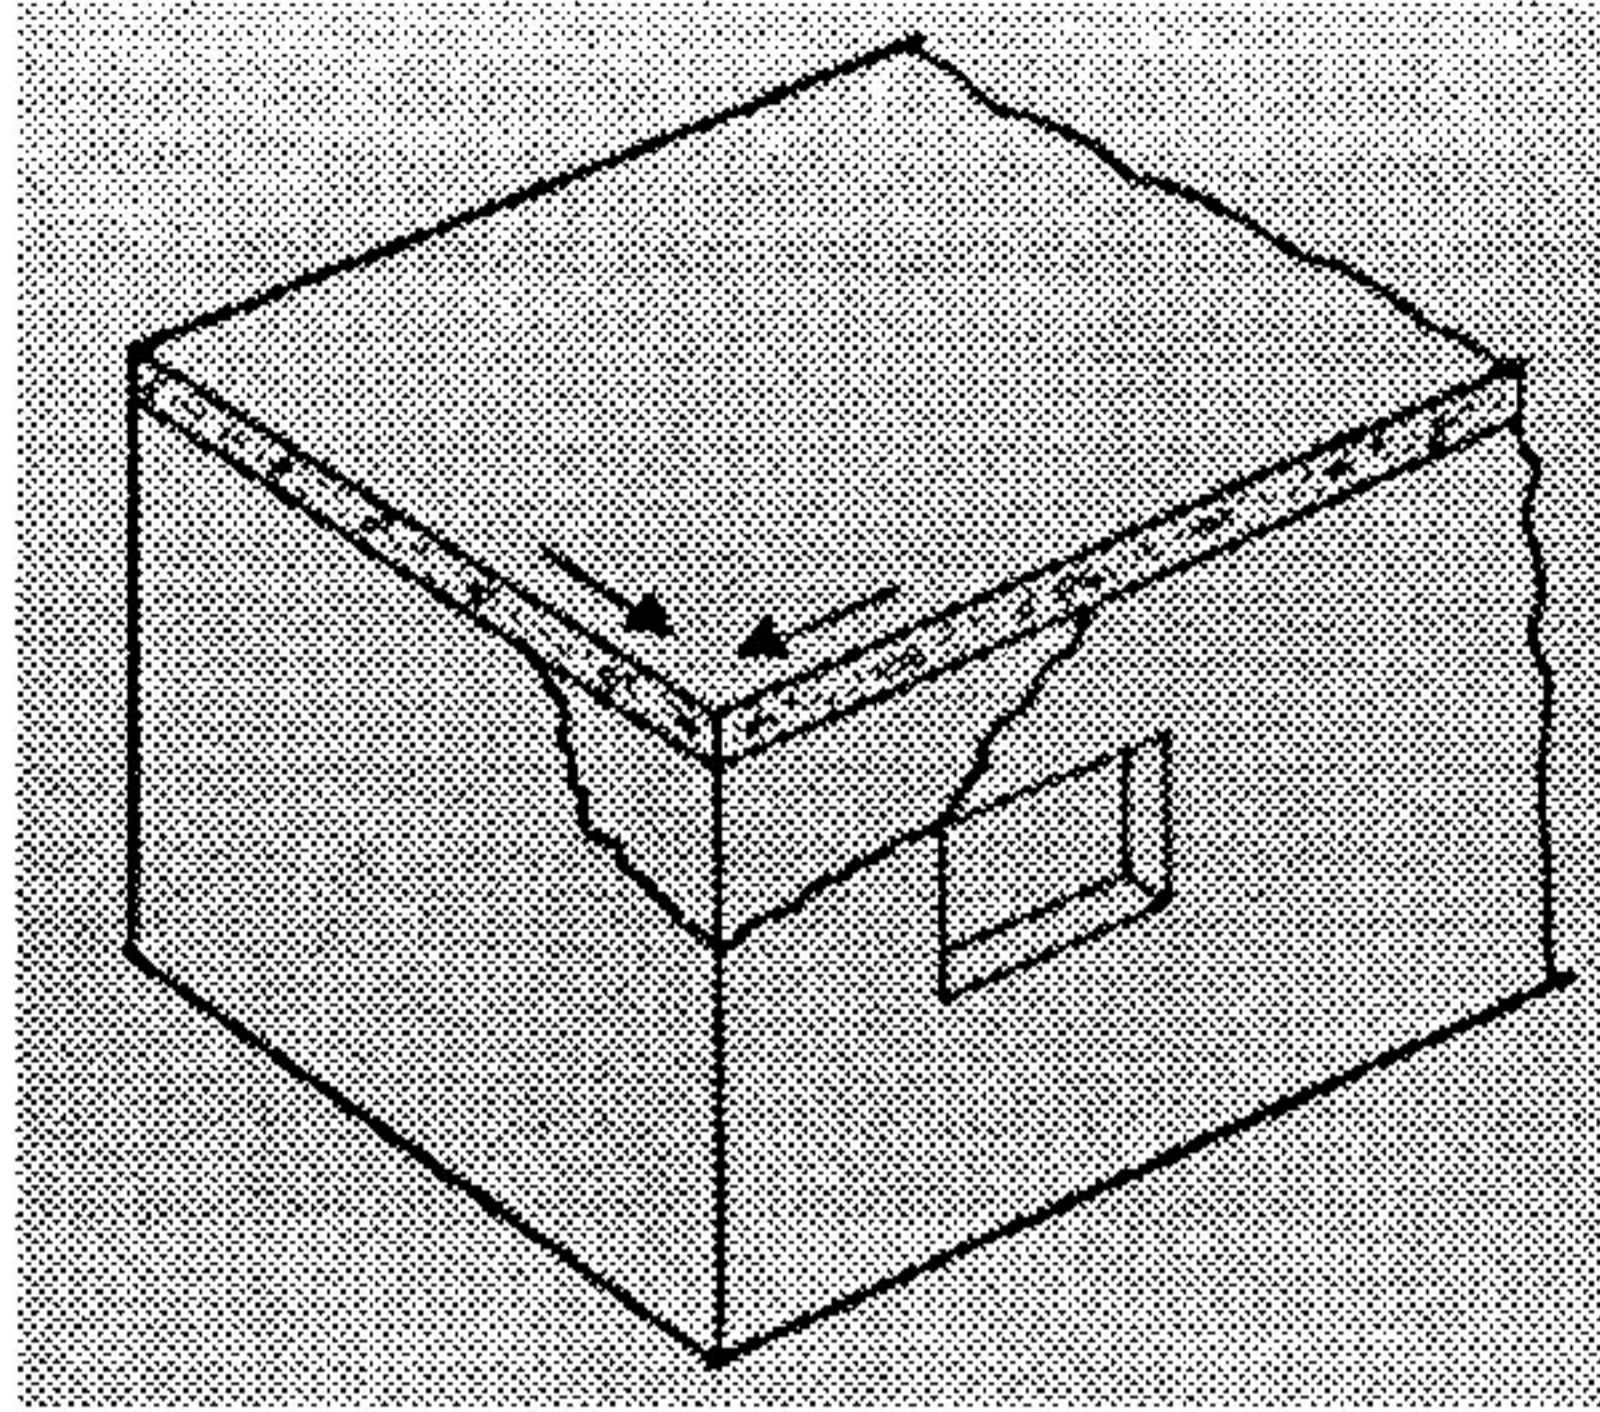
Fissura típica presente no topo da alvenaria paralela à largura da laje. [22]
